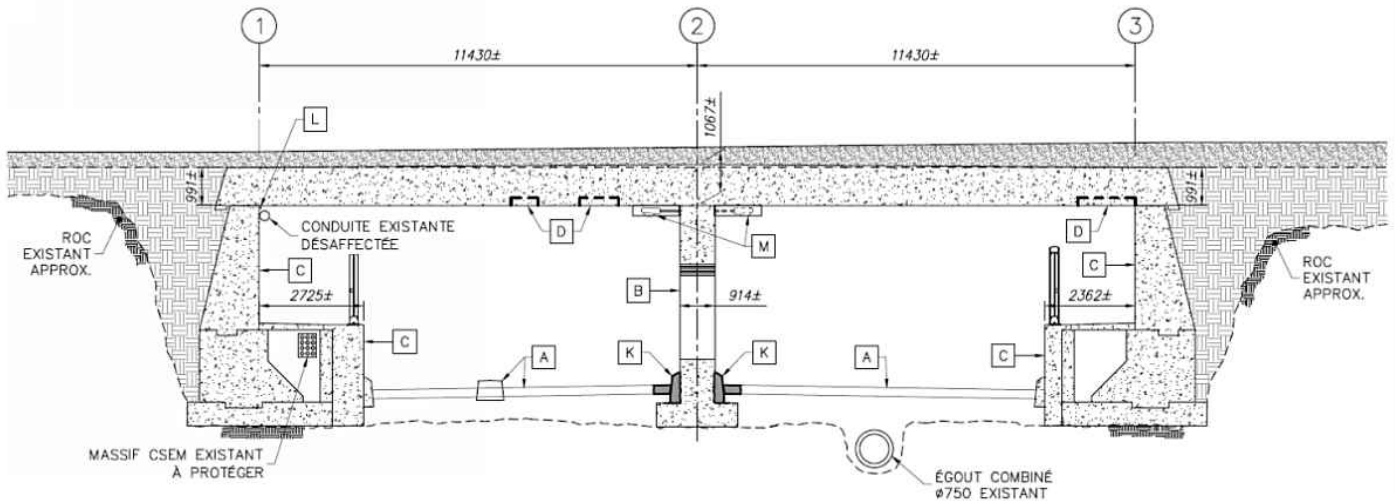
Extrait du plan d'ensemble – Vue en élévation
